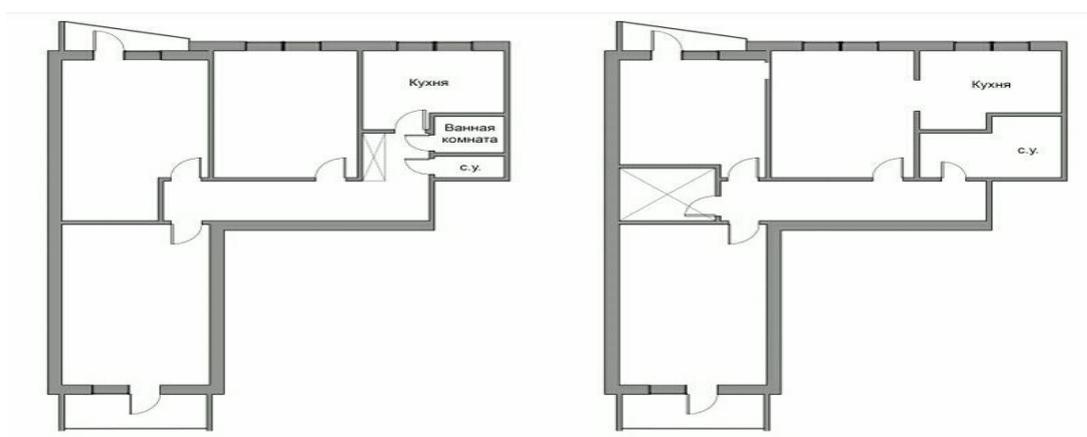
Пример перепланировки 3-комнатной квартиры.
